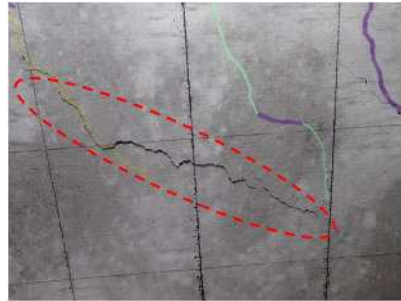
段差を伴うひび割れ (軽量 RC-20)
